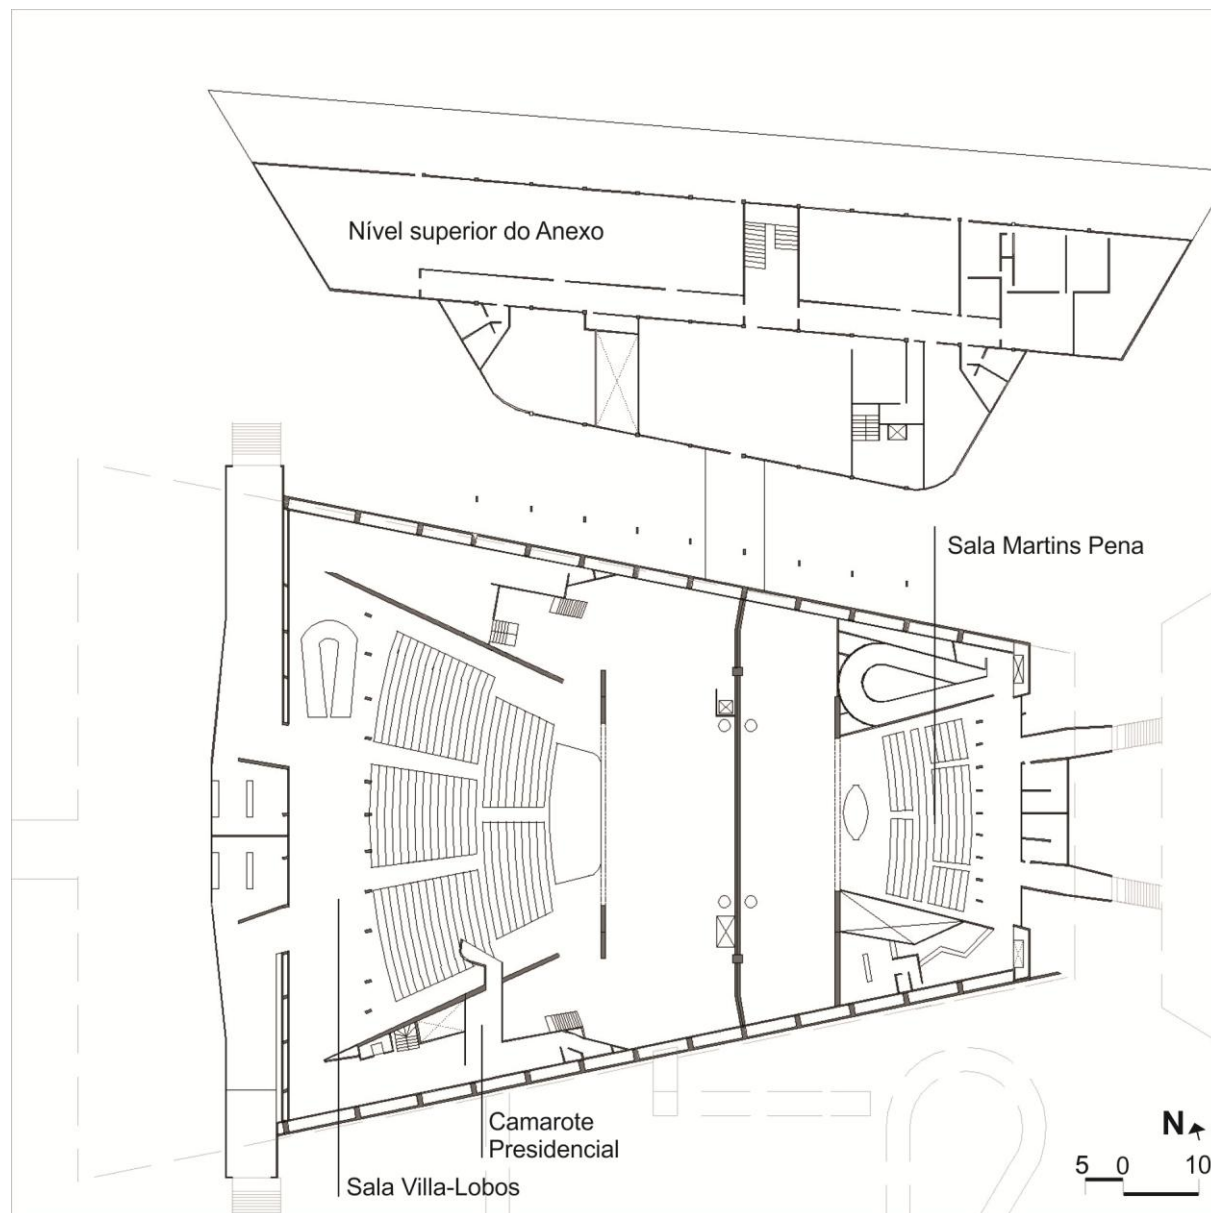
Planta Baixa - Subsolo 1 (-3,80 m).
